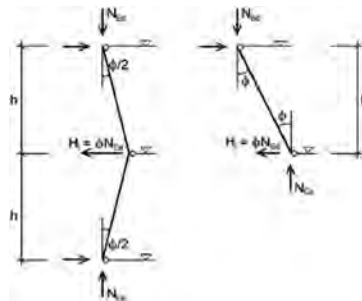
Effetti delle imperfezioni sugli orizzontamenti
